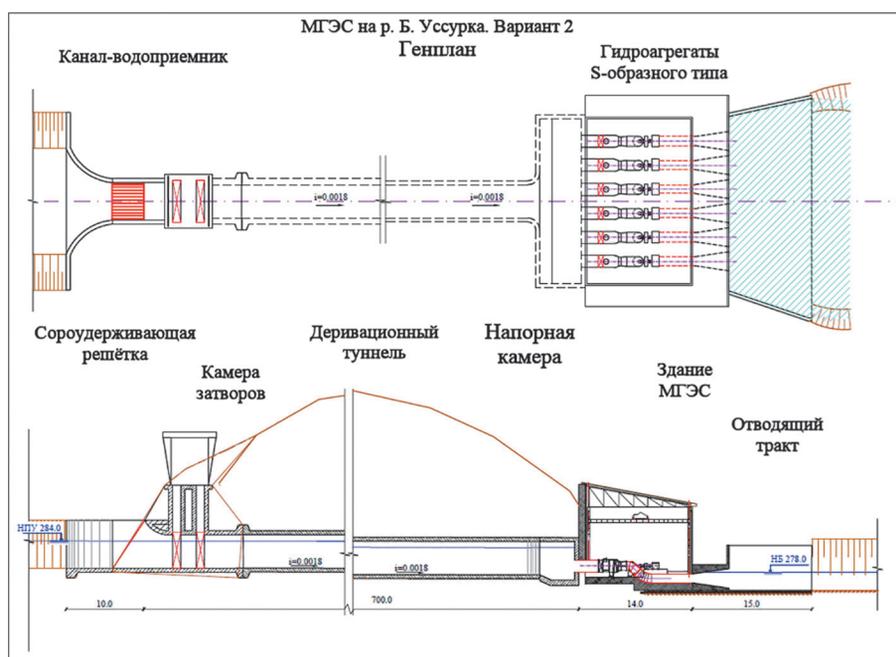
Генеральный план размещения гидротехнических сооружений (вариант 2)
